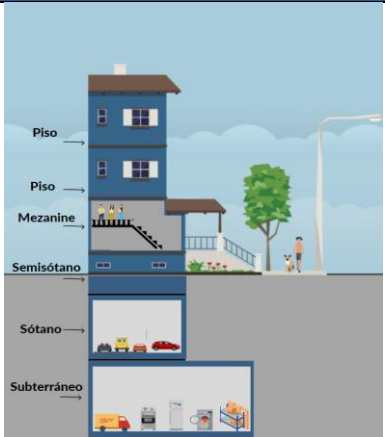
Opciones disponibles para el diligenciamiento de tipo de planta
